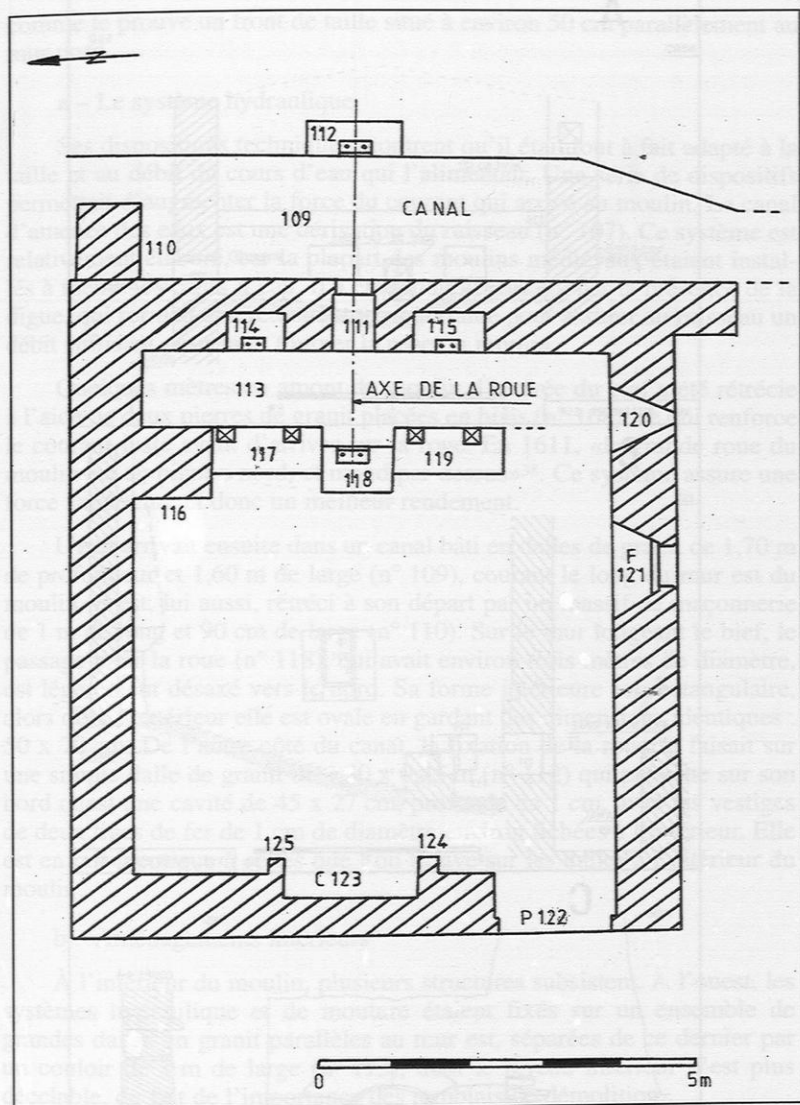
Plan du moulin. Pour la légende voir plan n° 3.
